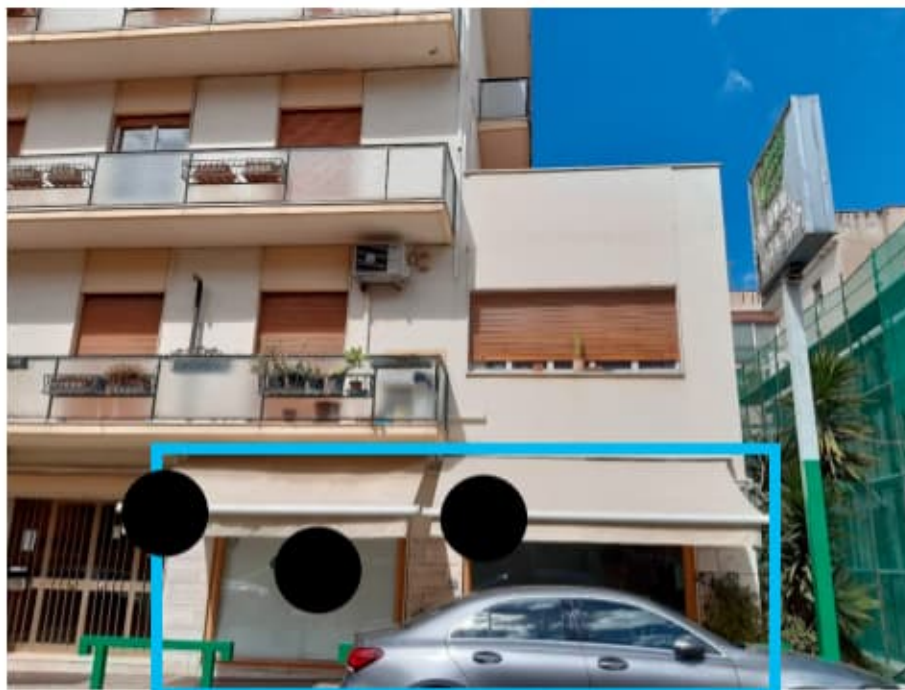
Prospetto lato Via Filippini - Stato di fatto
